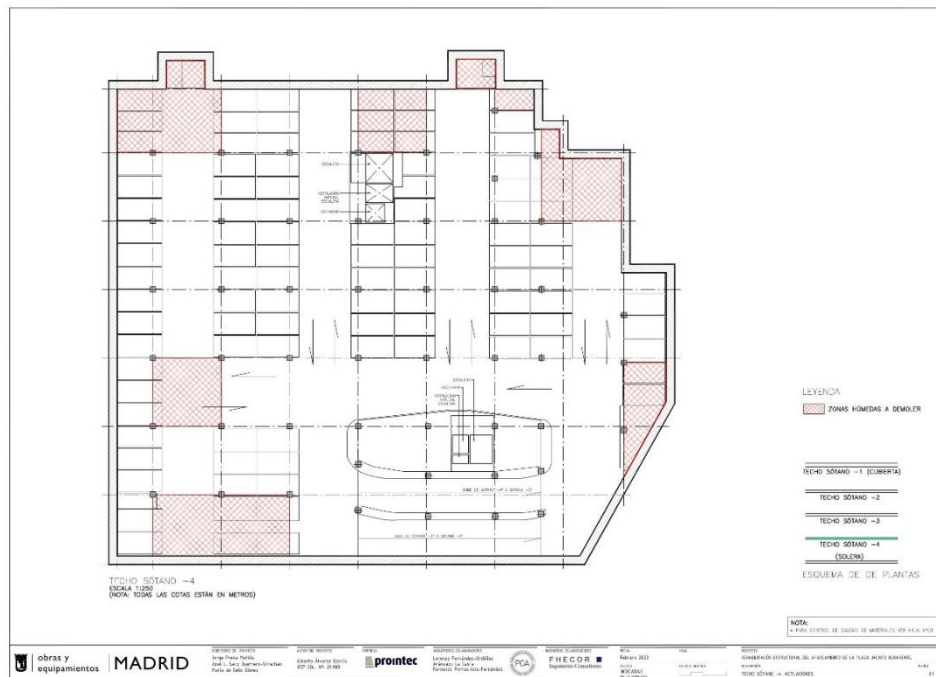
Plano Planta Sótano -3 que muestra las zonas confirmadas como húmedas, sombreadas en rojo
